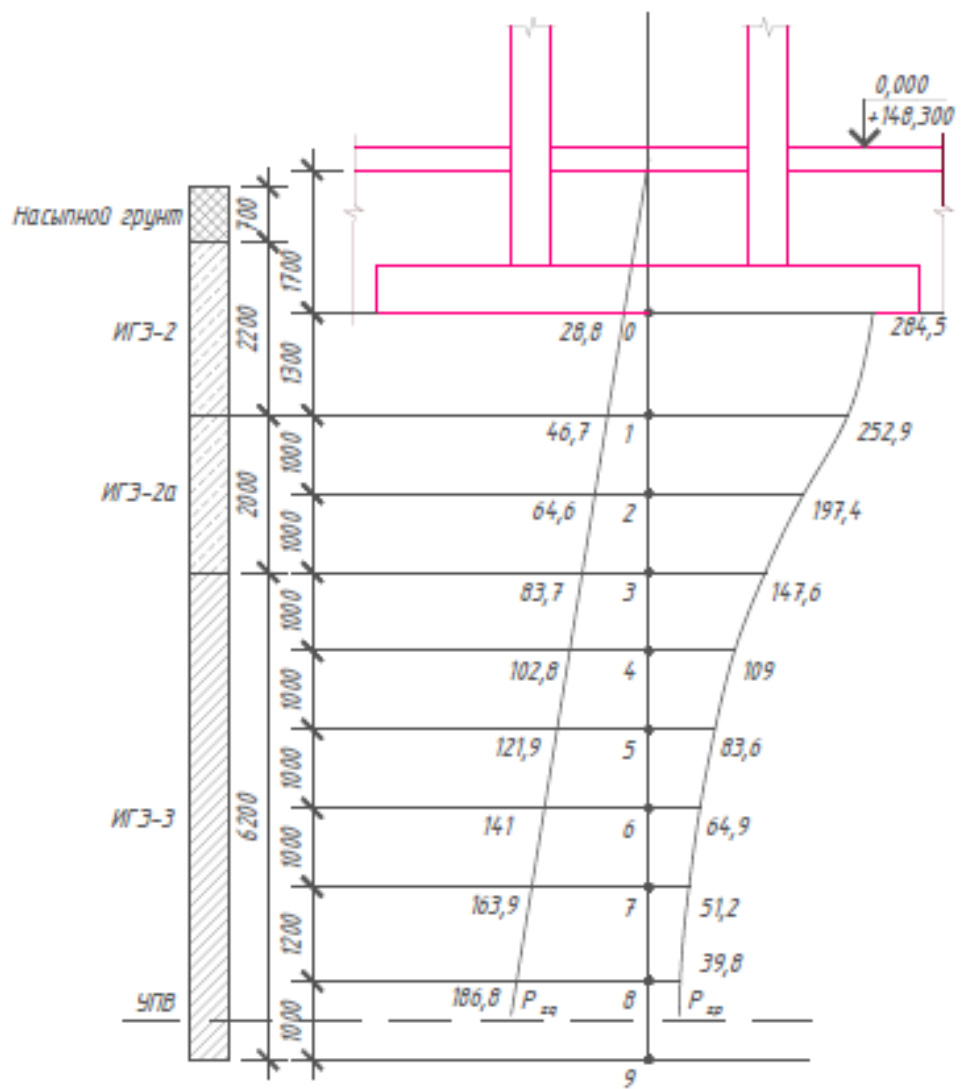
Расчетная схема к определению осадки фундамента методом послойного суммирования под внутренние колонны (в осях Г/10 и Д/10)
